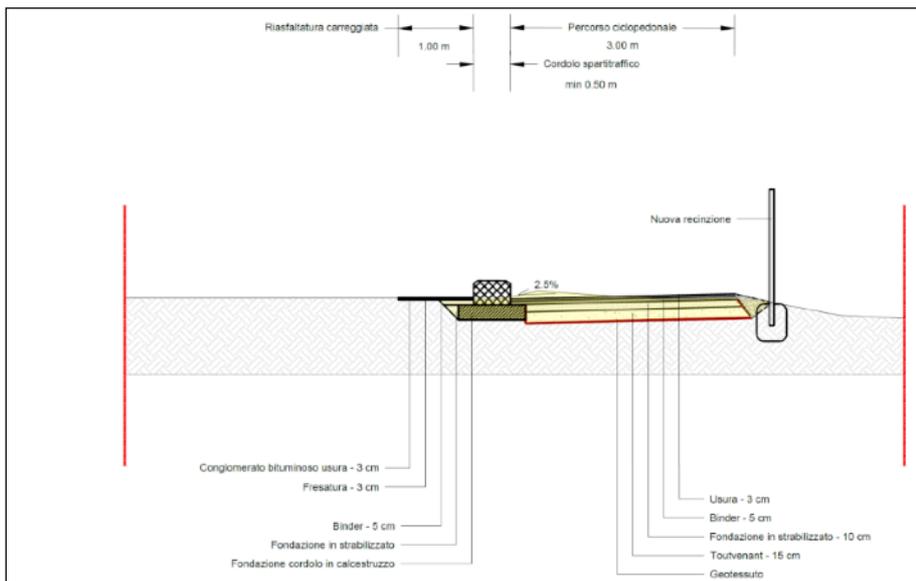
Sezione C29 – Esempio di sezione a raso con pacchetto bituminoso e cordolo di separazione da 50 cm - Sezione C24 – Sezione con finitura in stabilizzato
